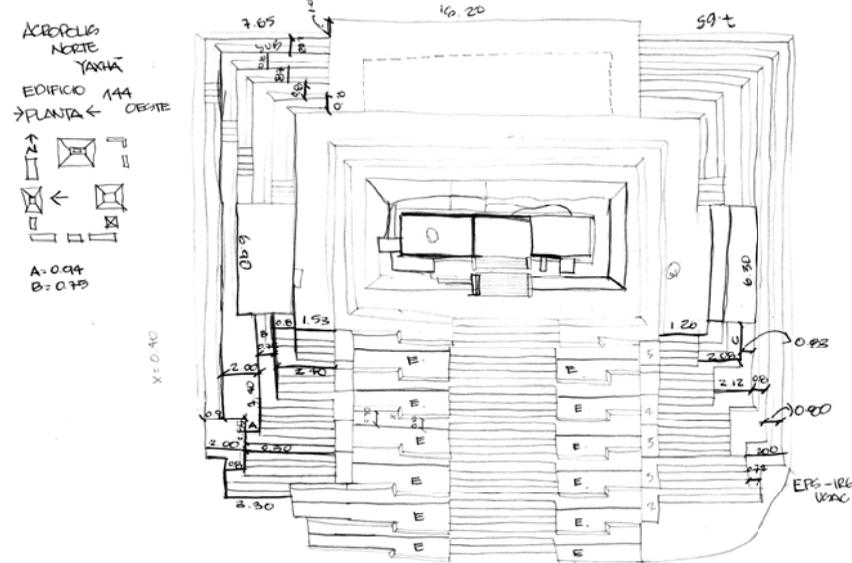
Planta del edificio 144, escaneado de ficha de campo. Fuente: RAE-2007
